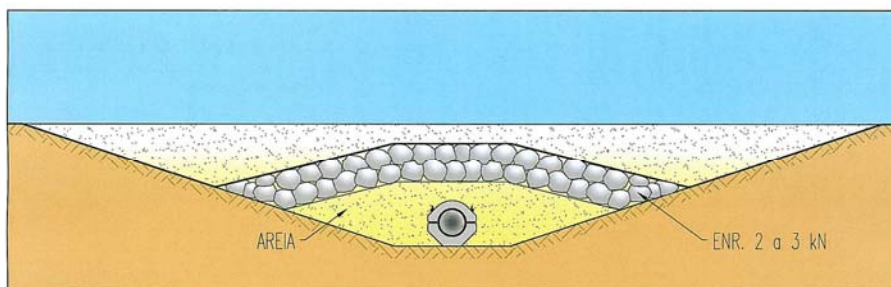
Troço na zona de rebentação. Perfil transversal tipo
